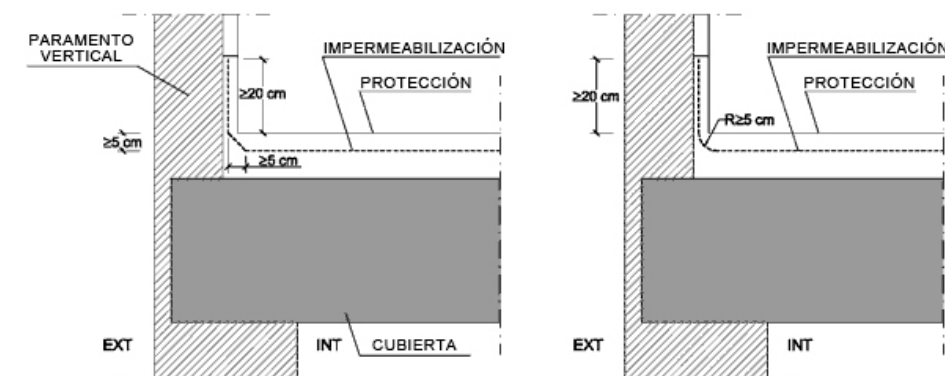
Encuentro de la cubierta con un paramento vertical
